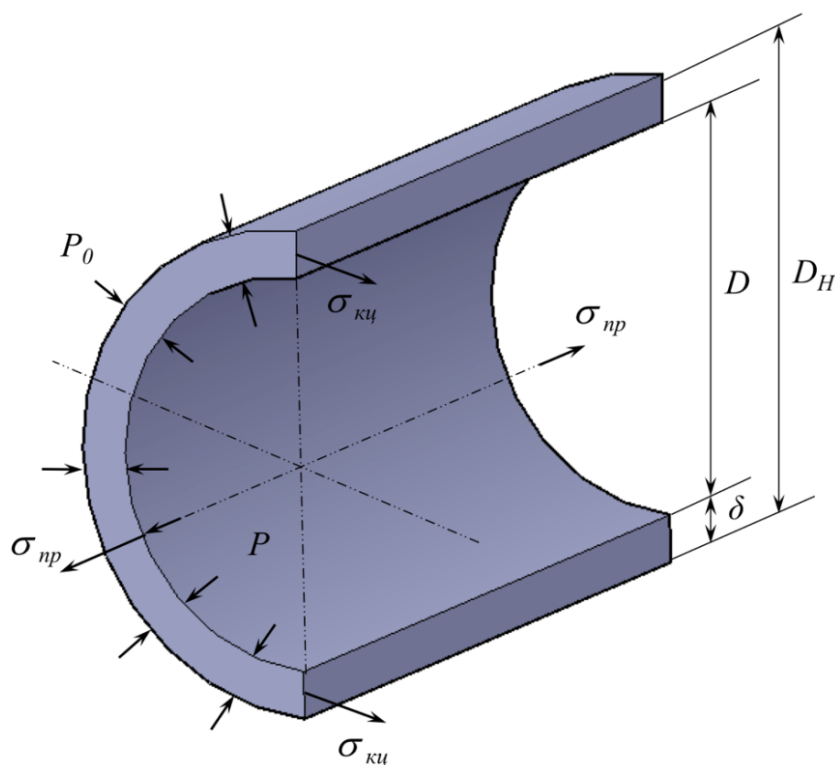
Расчетная схема нагружения подземного трубопровода
